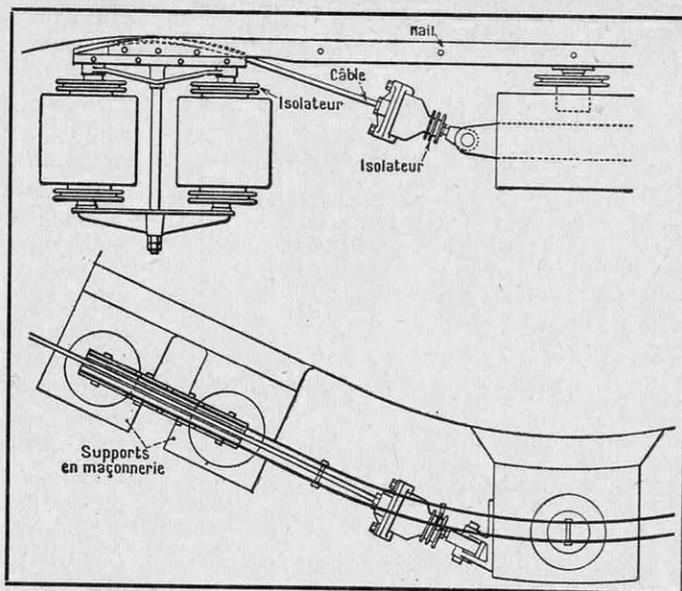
VUE LATÉRALE ET VUE PAR DESSUS DE L'INSTALLATION D'ARRIMAGE DES CÂBLES AU SOMMET DU PYLÔNE INTERMÉDIAIRE DE KER ZU
